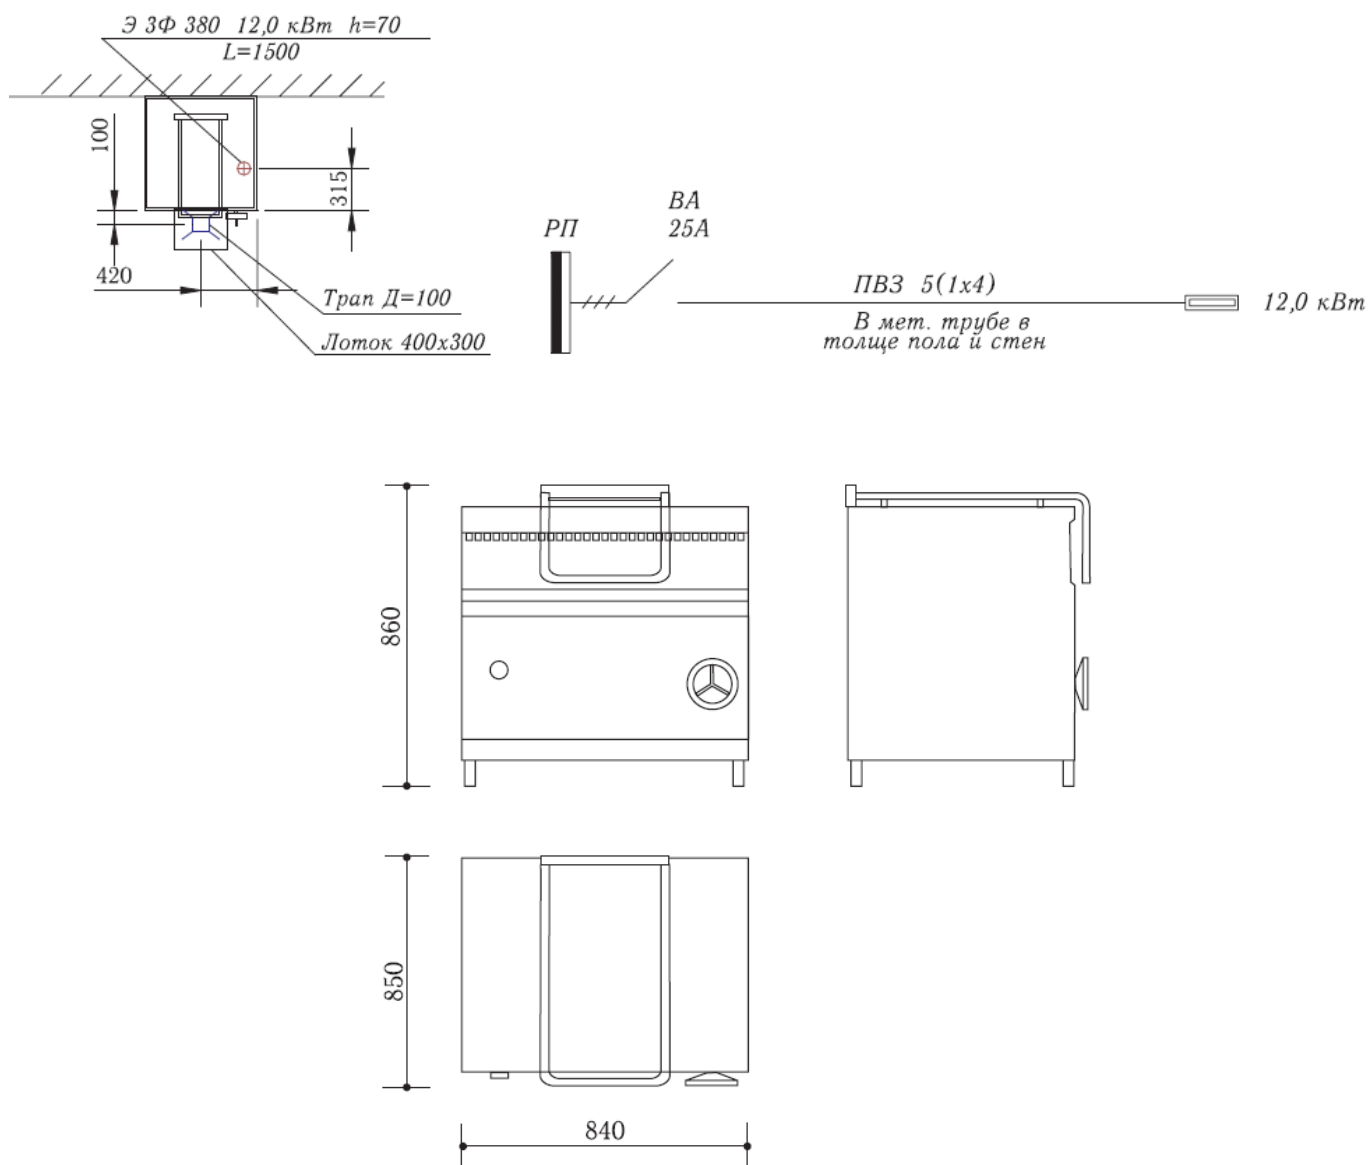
Схема подключения и габаритные размеры закрытой сковороды ЭСК 90-0,47-70
